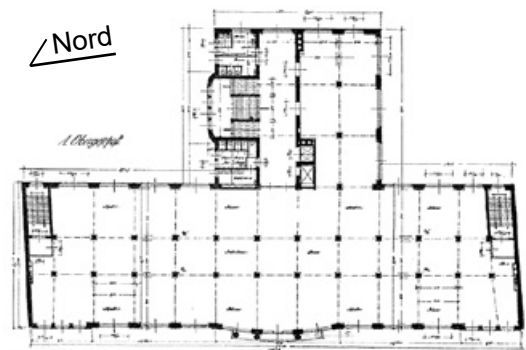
Grundriss 1. Obergeschoss
